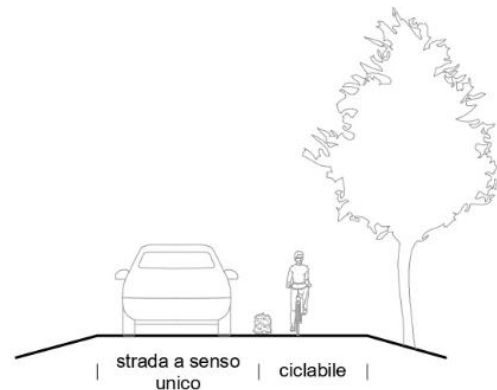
Focus progettuale: L'asse pedonale verde. Planimetria e sezione stato post intervento.
